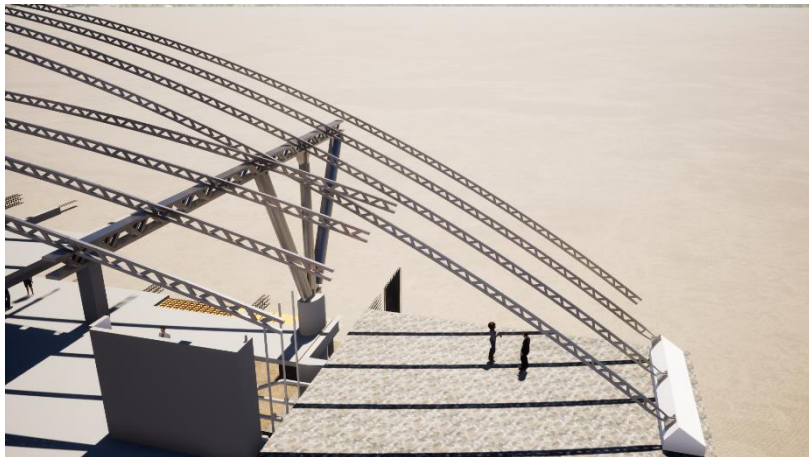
Detalle de anclaje de perfiles tubulares y tipo I en base de hormigón armado.
